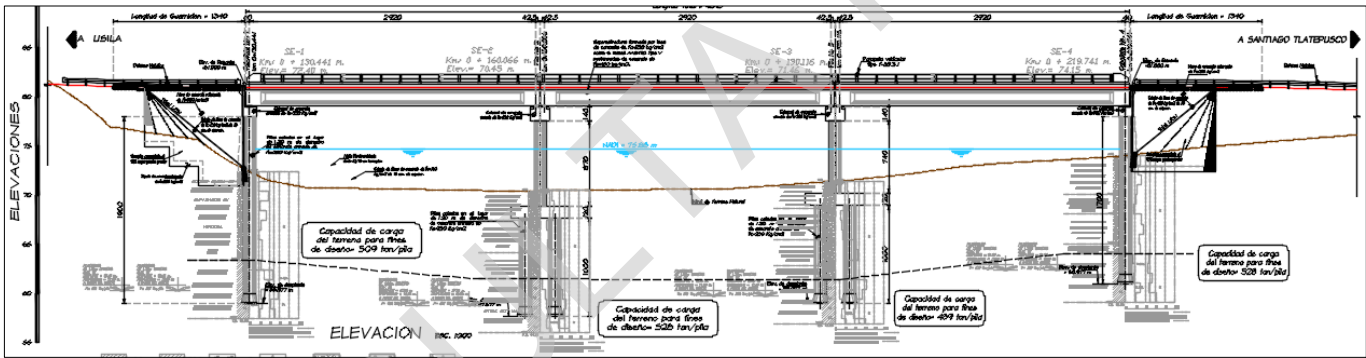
Elevación general del proyecto de construcción del puente "Tlatepusco".
